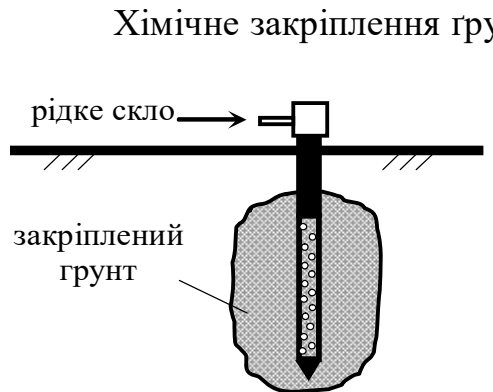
Схема хімічного закріплення ґрунтів.
